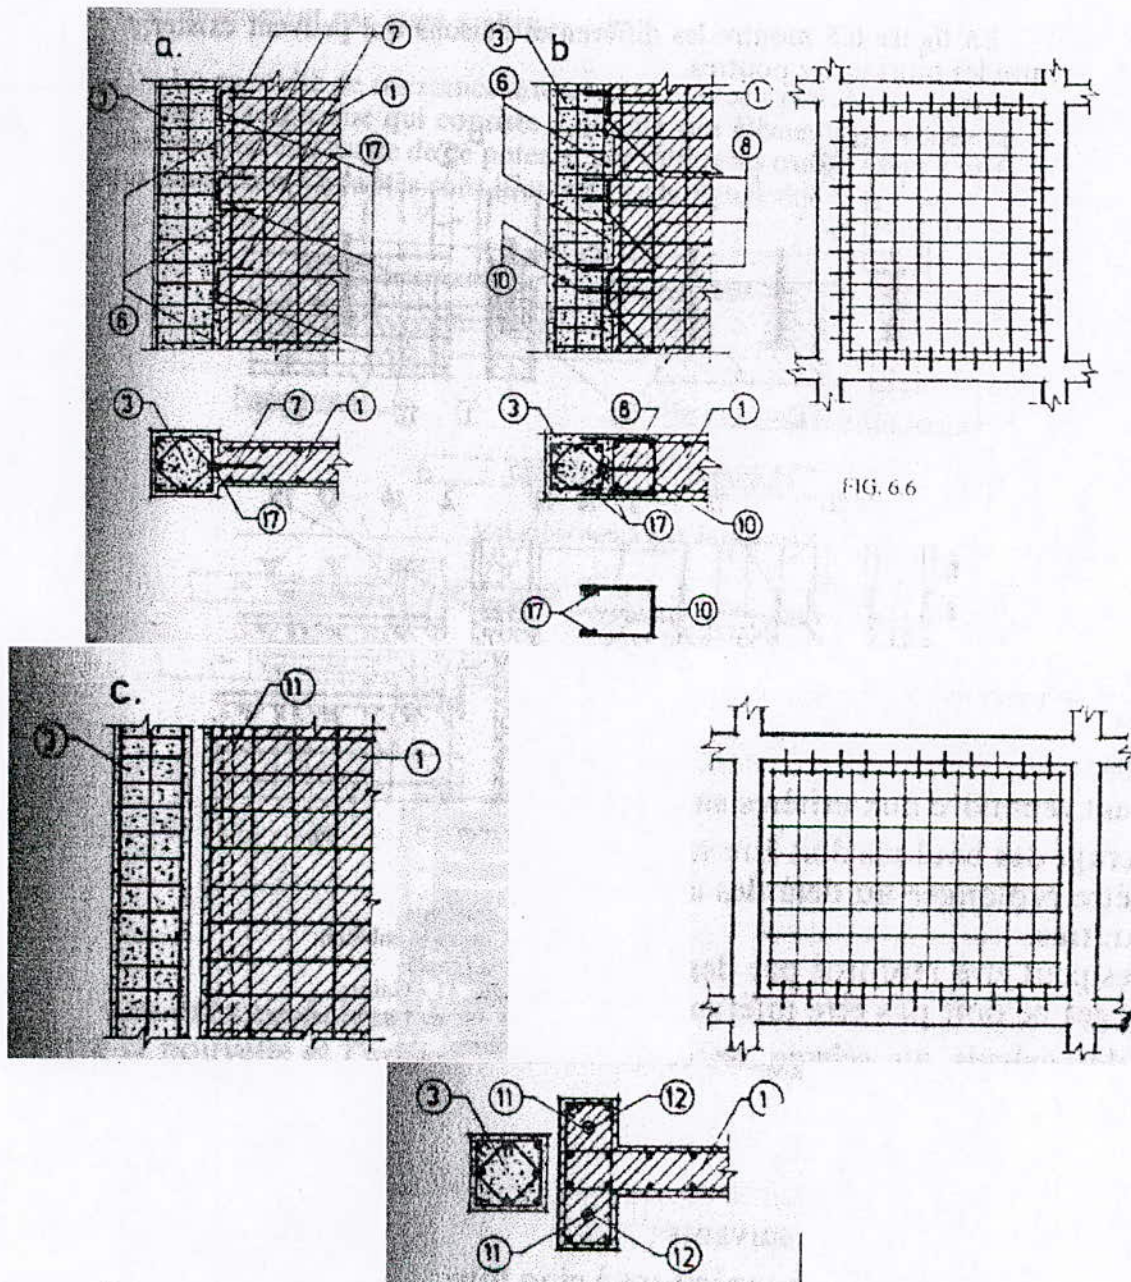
Liaisons mur de renforcement-poutre/poteau
